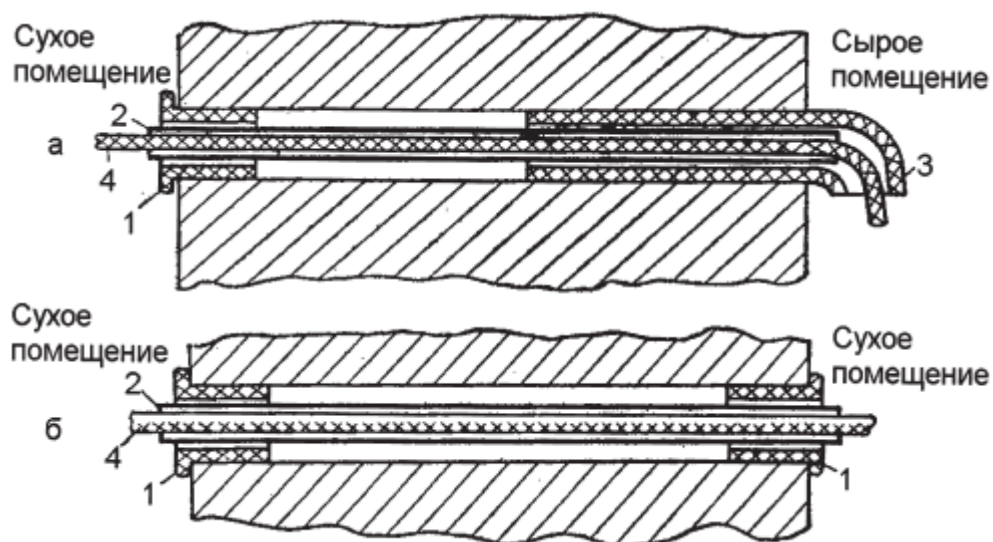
Проход проводов через стену: а – из сырого в сухое помещение; б – из сухого помещения в сухое: 1 – втулка; 2 – изоляционная трубка; 3 – воронка; 4 – провод
